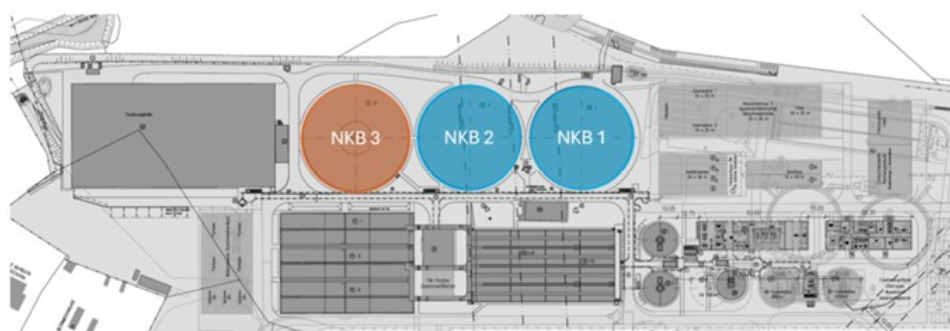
Lageplan bestehendes Nachklärbecken 3 (orange) und zu sanierende Nachklärbecken 1 und 2 (blau)
